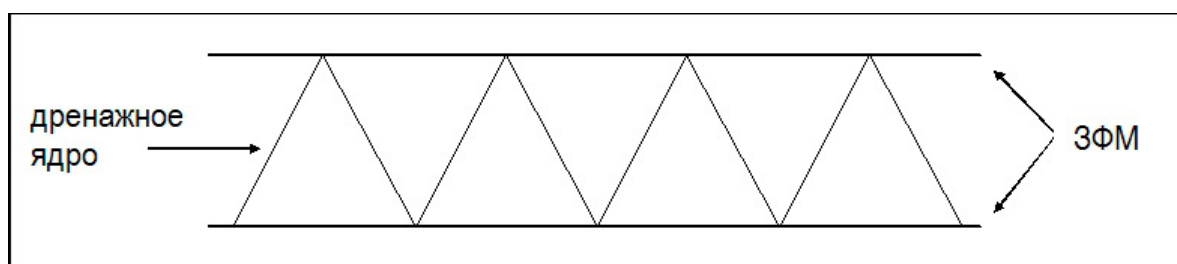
Схема дренажного геокомпозита с ЗФМ (поперечный разрез)
